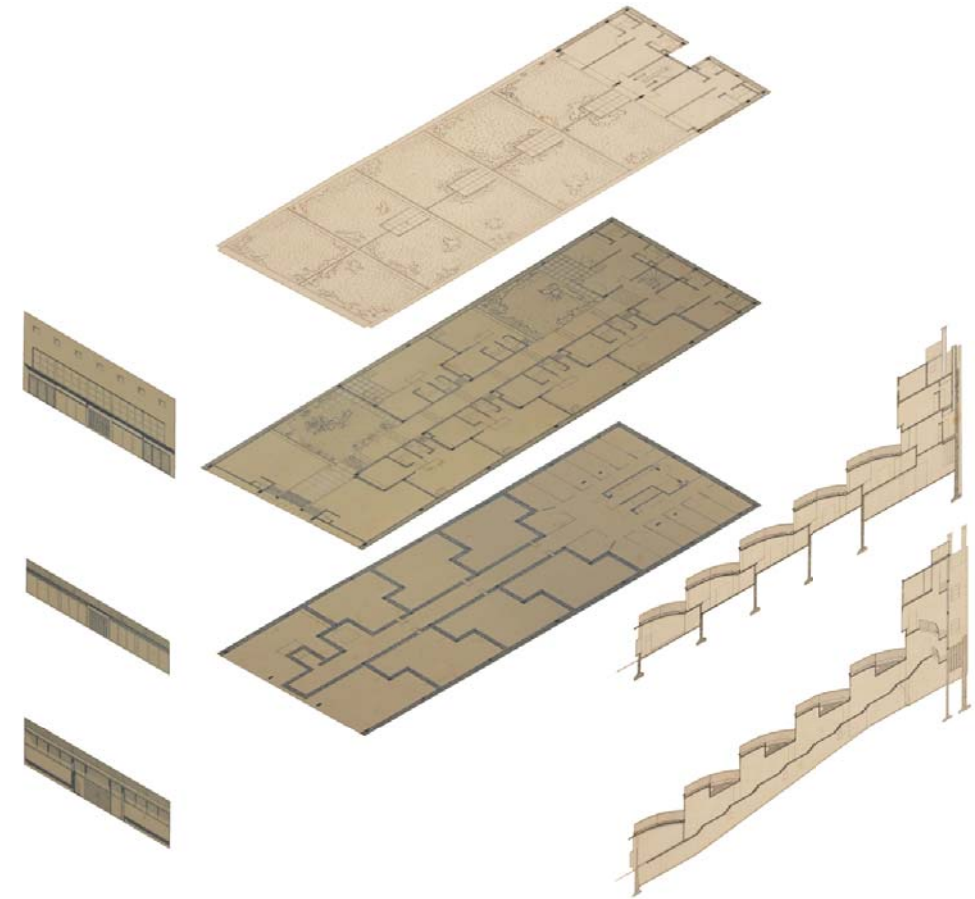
Puesta a escala de las planimetrías previas disponibles
